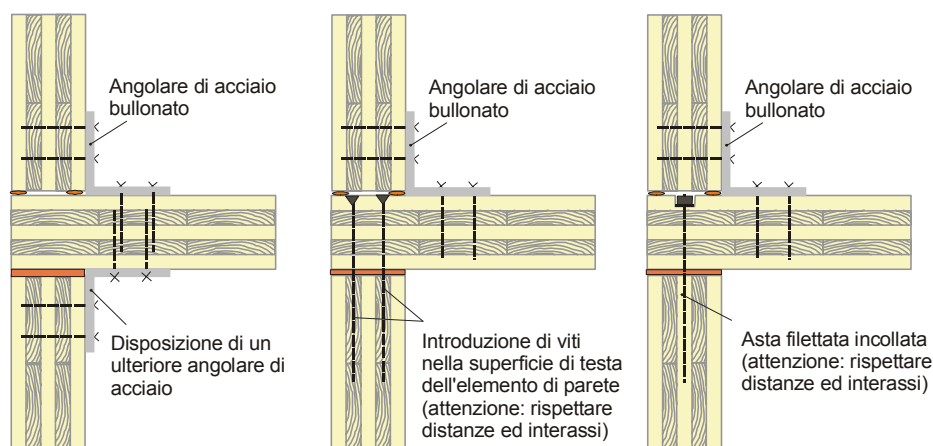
Giunzione parete-solaio-parete, esempi rappresentativi della realizzazione della connessione
